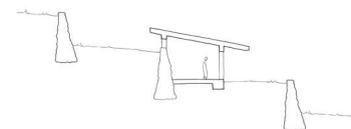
Esquema de vivienda apoyada en dos planos. Casa de arrimo.
